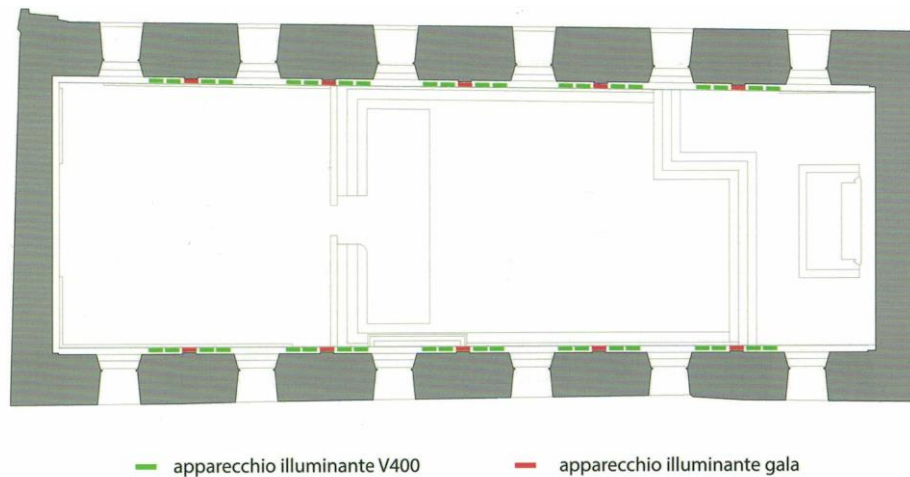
Disposizione degli apparecchi illuminanti - pianta
